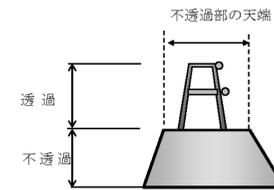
部分透過型砂防えん堤越流部側面図(例)
